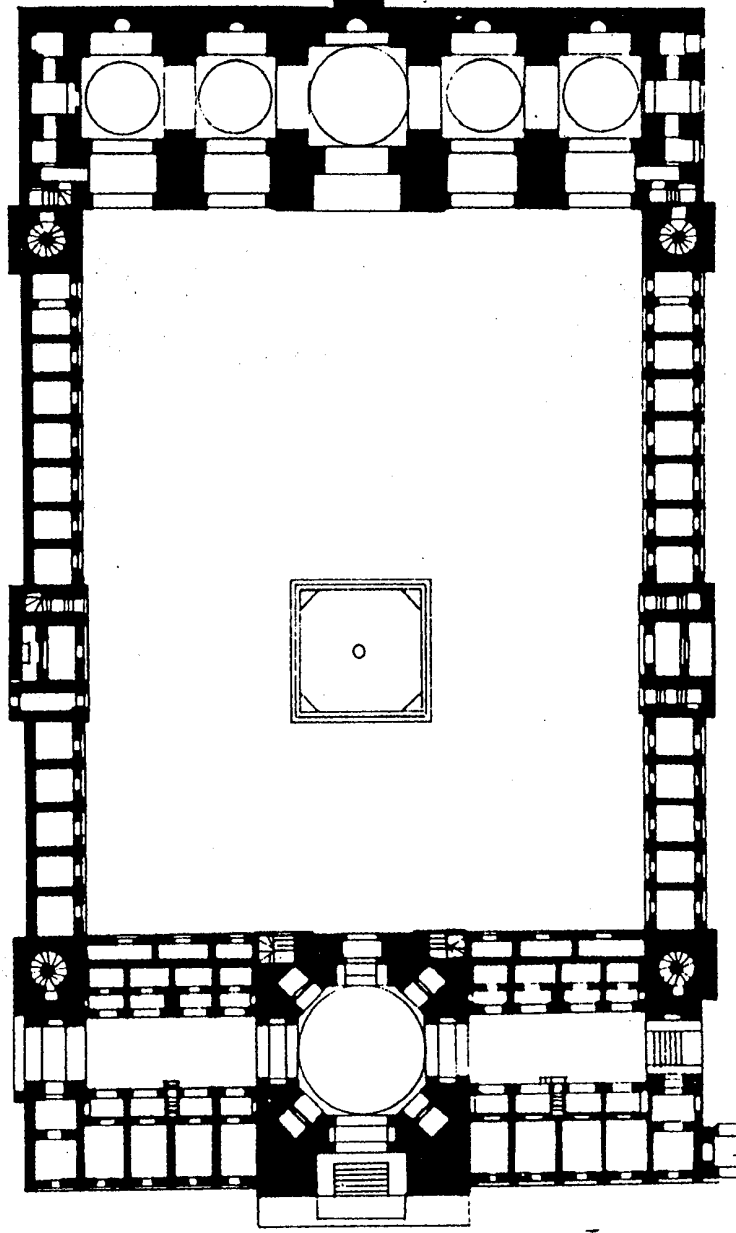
مسقط أفقي للجامع الأزهر الحالي (عن ، Creswell)
